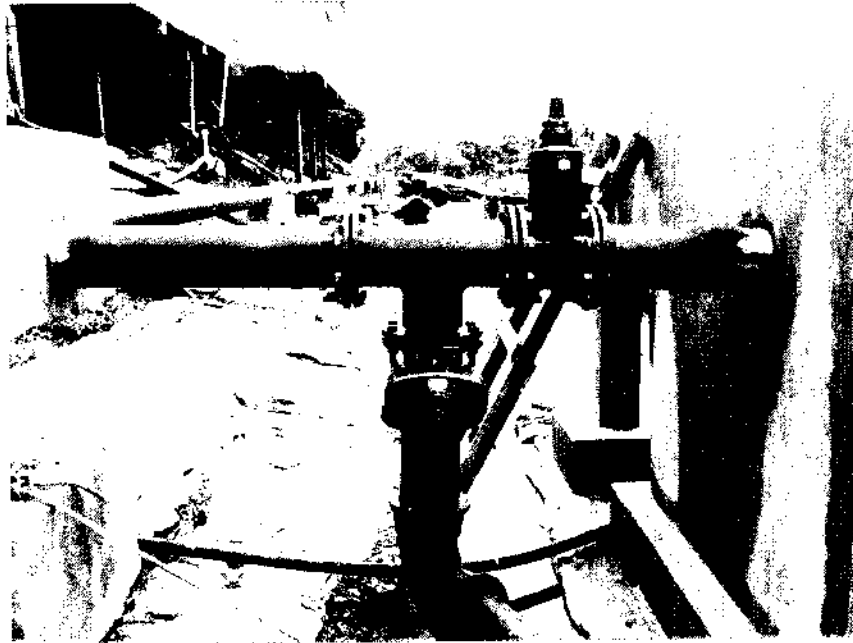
Vista do extravasador da elevatória executado
